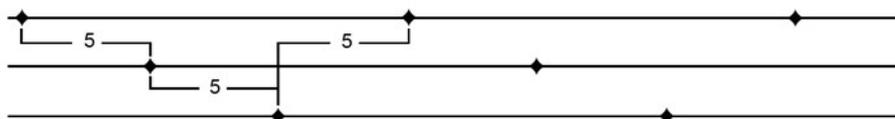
Размещение на проводах 3-х фазных ВЛ.
